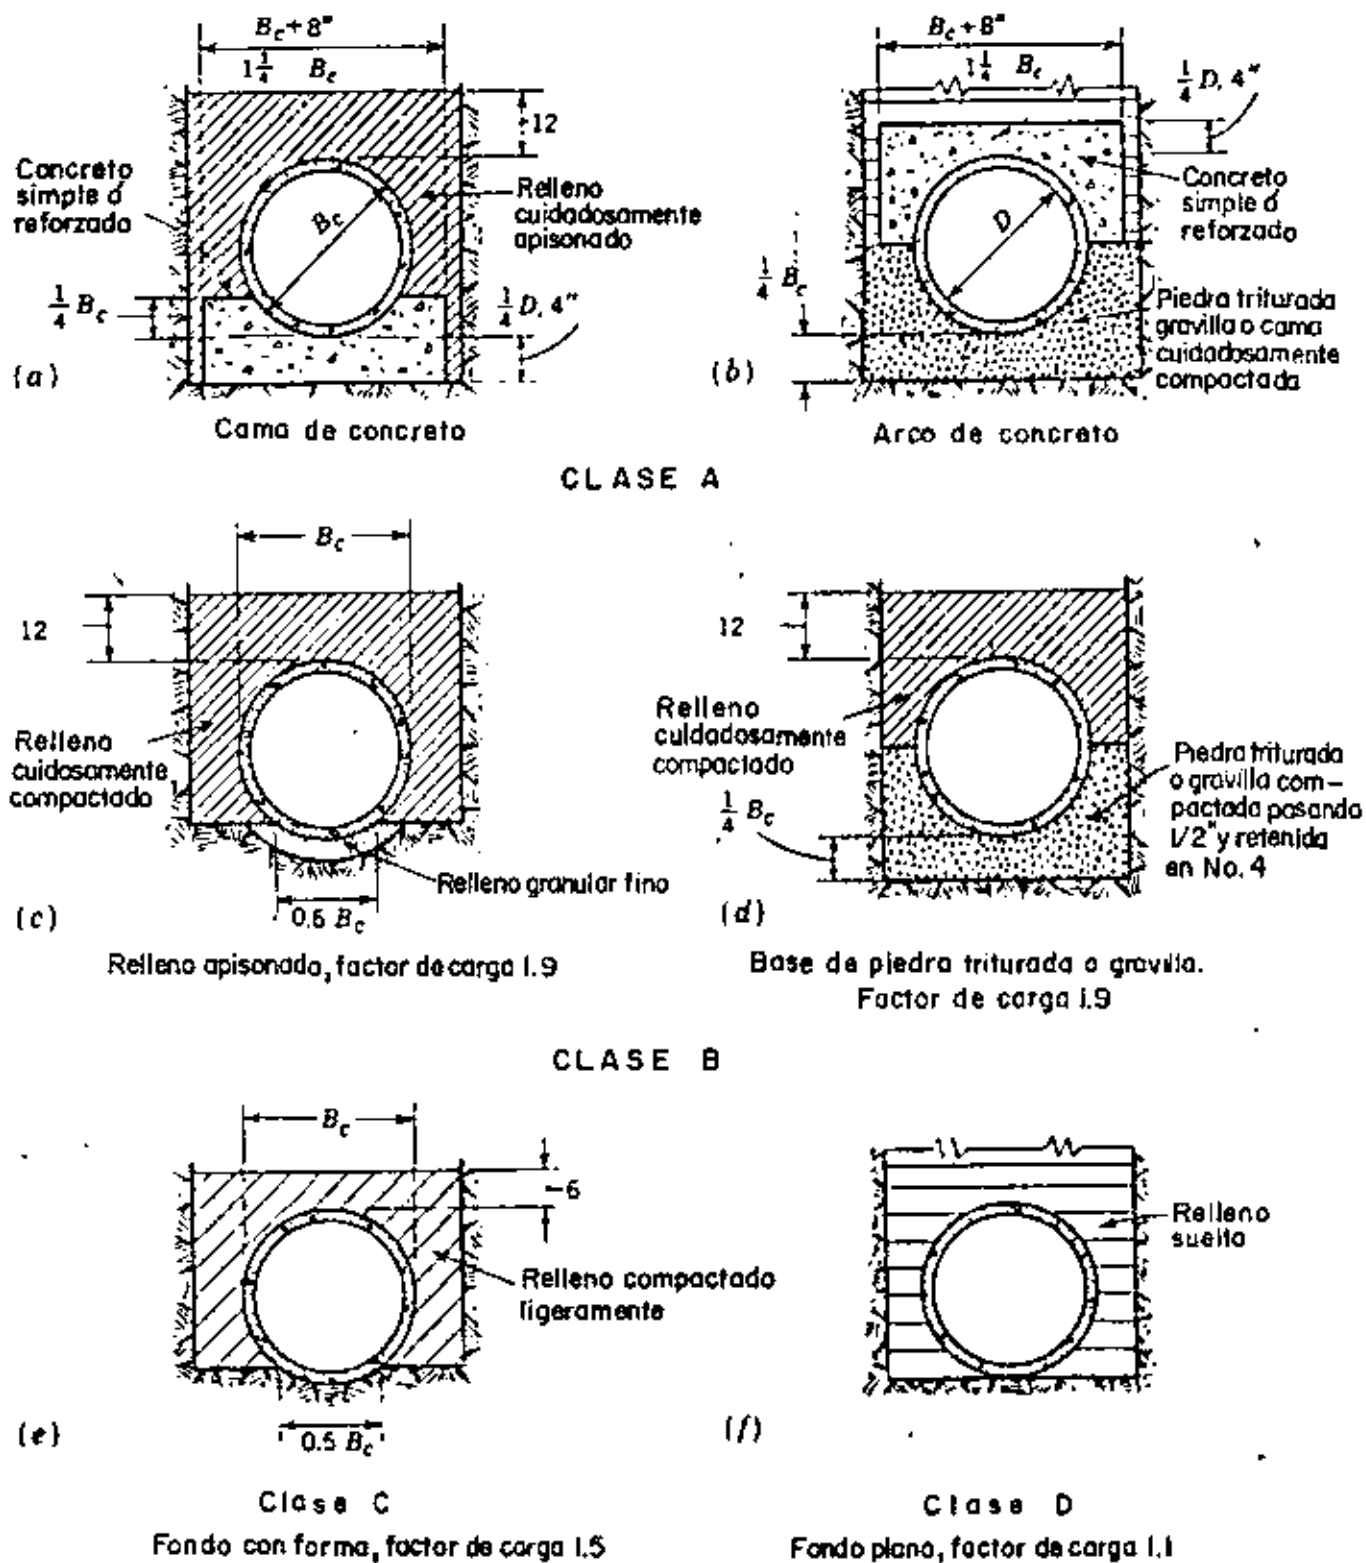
CAMAS DE TUBOS EN ZANJA
